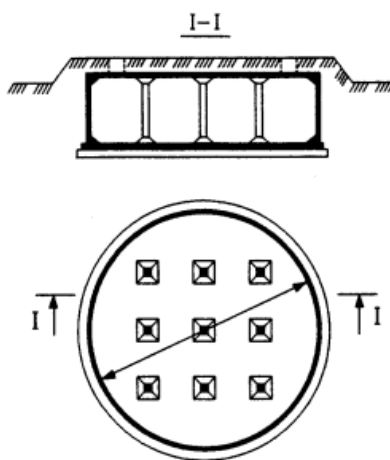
Монолитный цилиндрический резервуар с безбалочным покрытием
